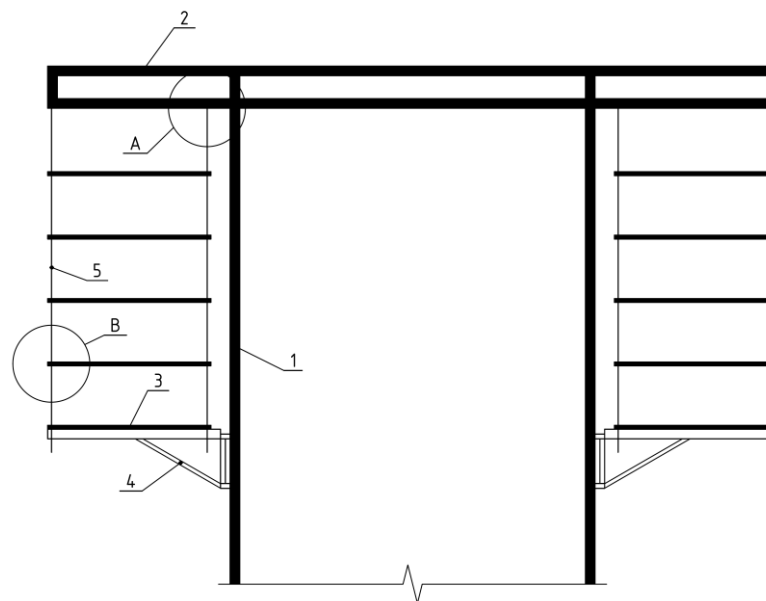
Схема монтажа подвешенных перекрытий: 1 – несущий ствол; 2 – консольный ростверк; 3 – плиты перекрытий; 4 – консольная опалубка; 5 – подвески
